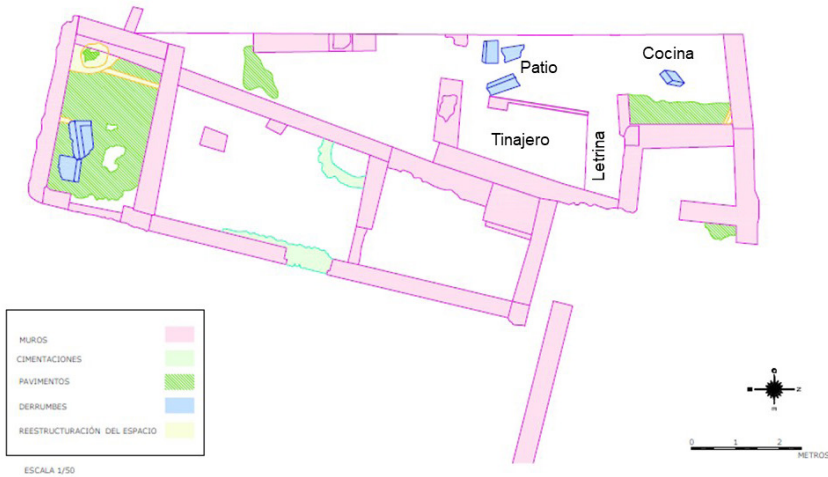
Planimetría del área excavada en 2024, identificando los diferentes espacios de la casa 22 y el gallinero o establo (Autores: equipo de excavación y Salmerón Architecture)
